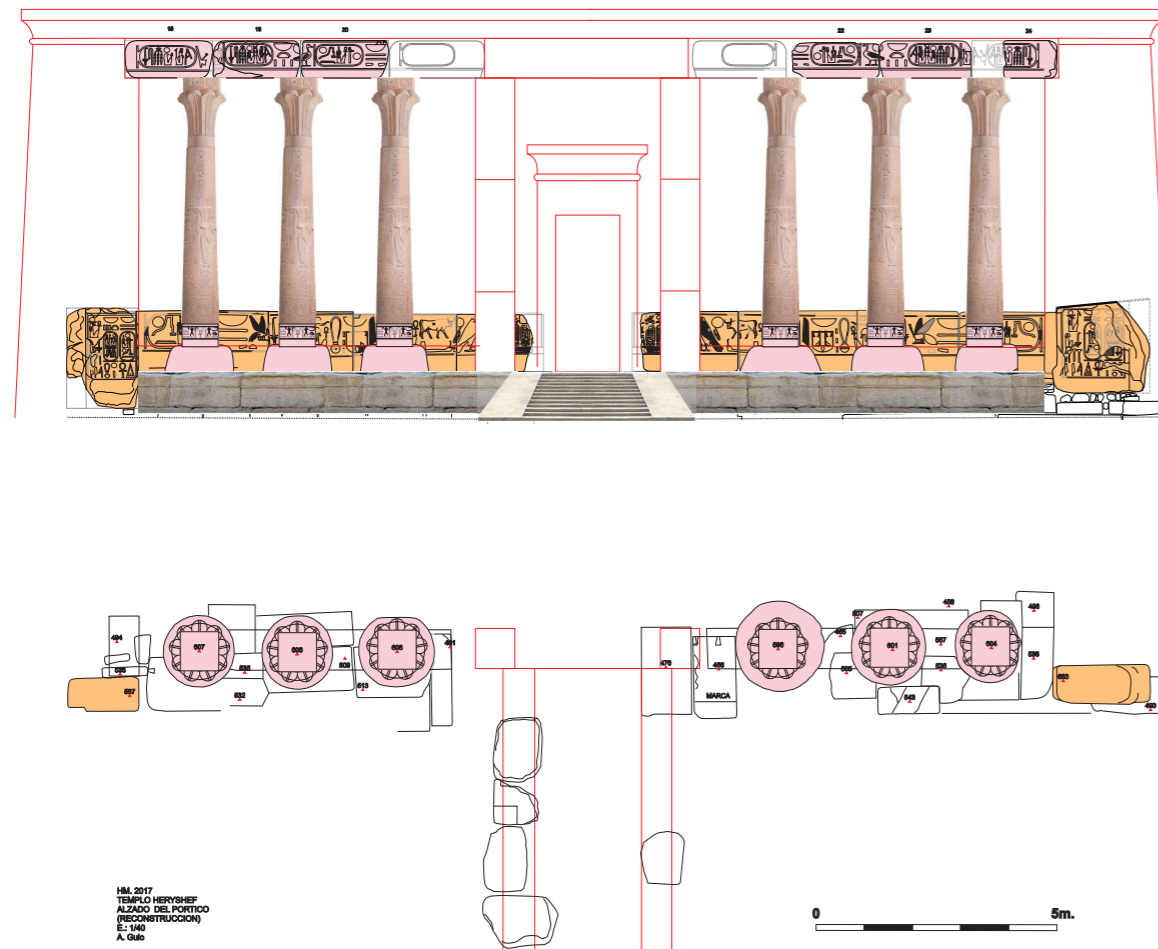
Reconstrucción de la fachada del pórtico. Dibujo de Antonio Guio.
